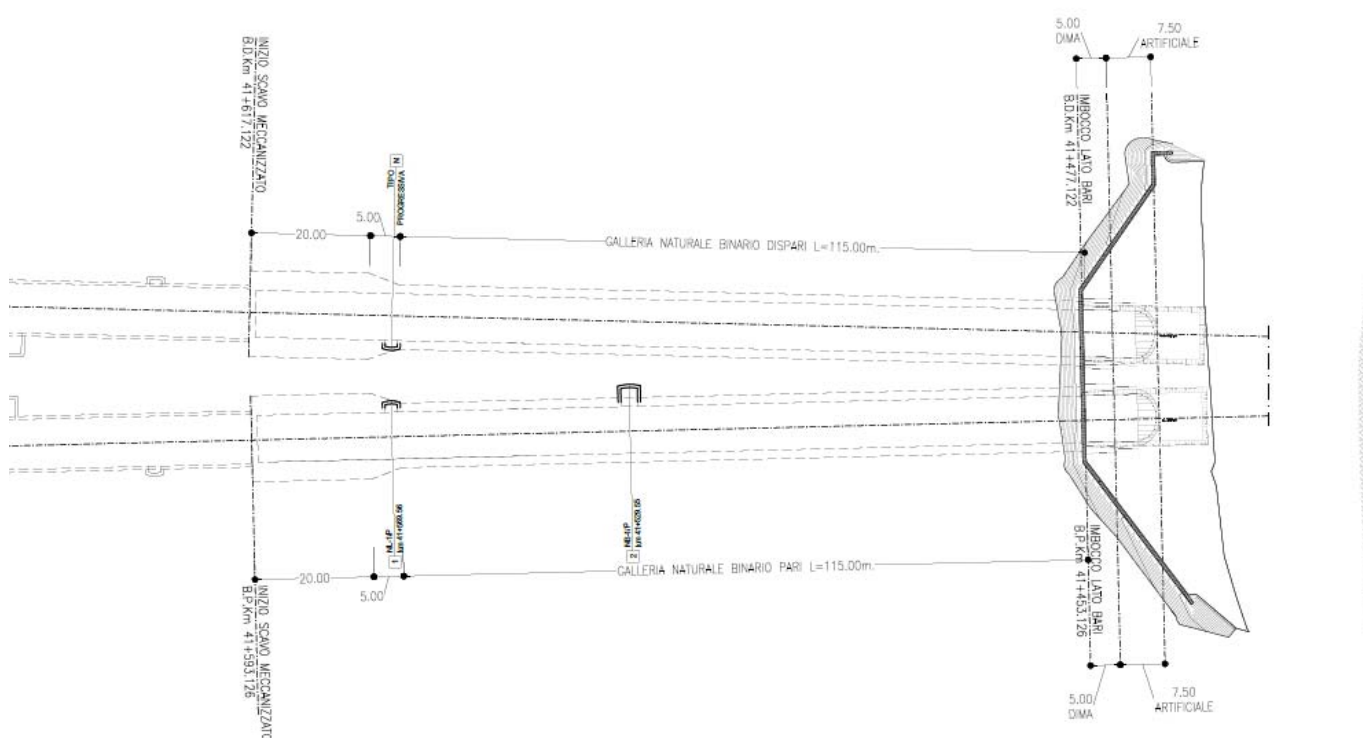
Planimetria inquadramento e poizione nicchie - imbocco lato Bari (pk 41+453.126 - 41+593.126 BP)
